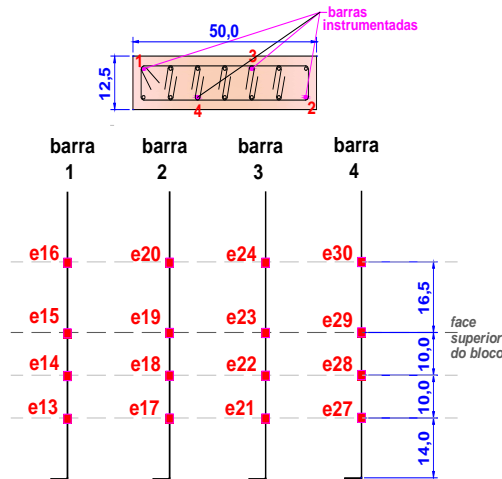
Posição dos extensômetros nas barras das armaduras dos pilares da série P500
